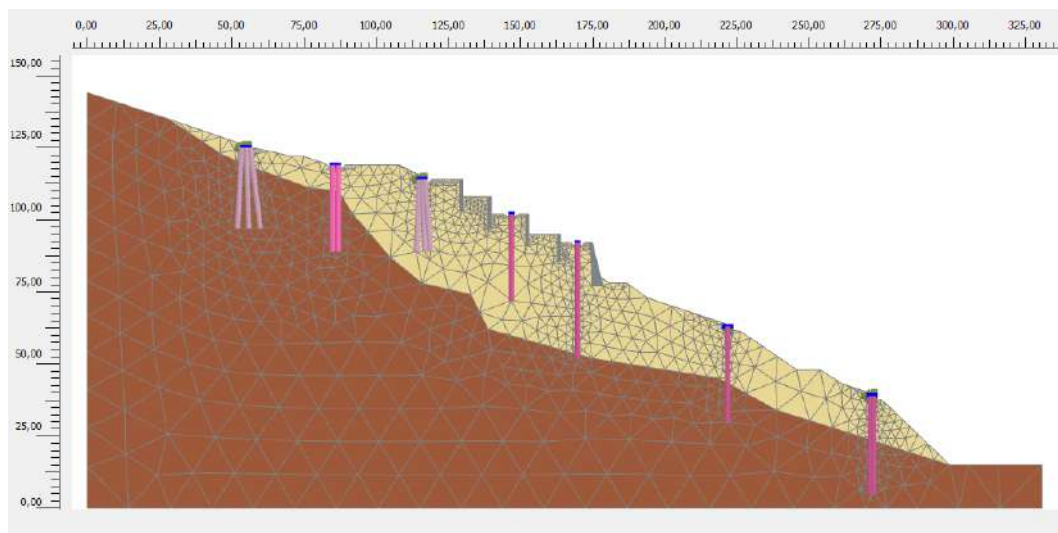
Mallado hipótesis 1 sistema de refuerzo mediante 7 filas de pilotes in situ en PK 0+040
